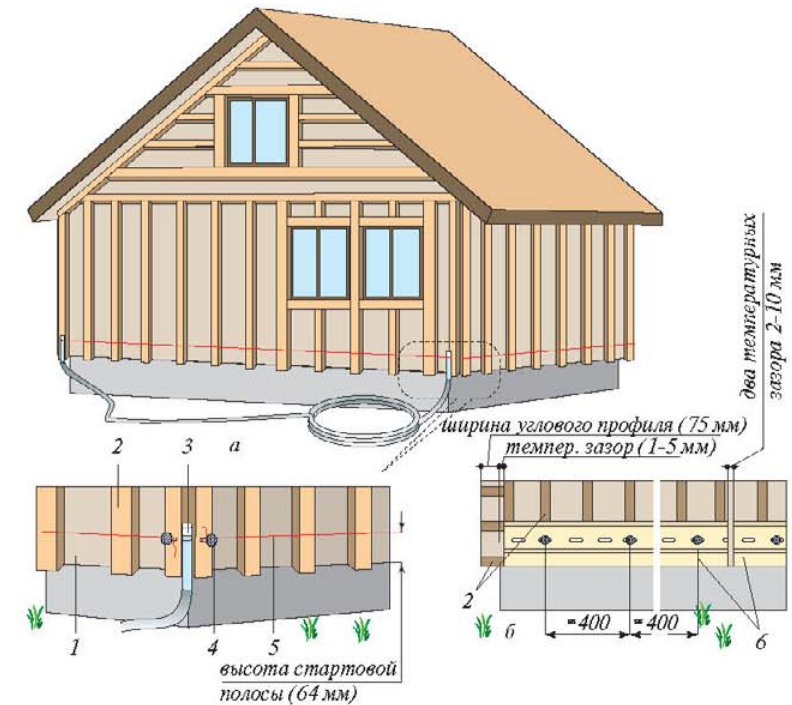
Монтаж стартового профиля (размеры в мм): а — отбивка горизонта; б — установка стартовых полос; 1 — стена; 2 — обрешетка; 3 — водяной уровень; 4 — гвоздь; 5 — шнурок; 6 — стартовая полоса
